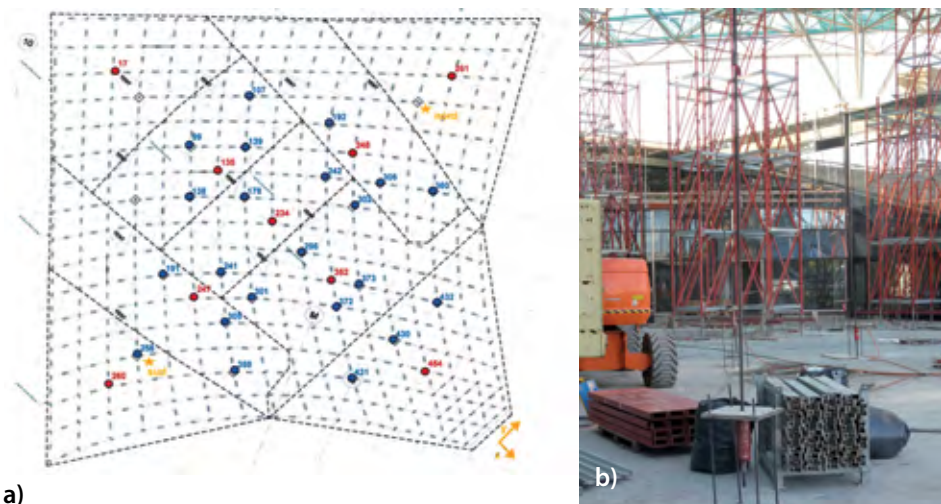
a) Disposizione in pianta dei punti di applicazione del carico sull'estradosso della struttura, b)
